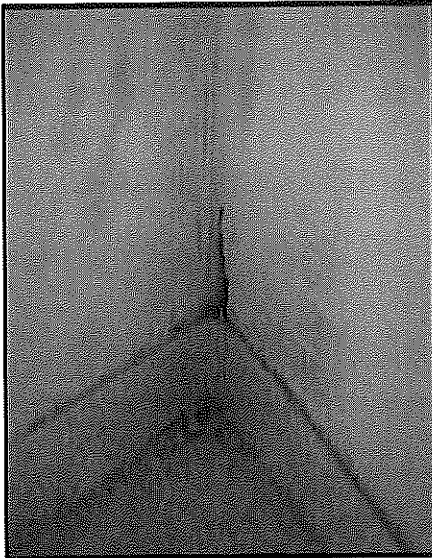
Flux d'air au niveau des liaisons périphériques (parois, plancher) dans la chambre
